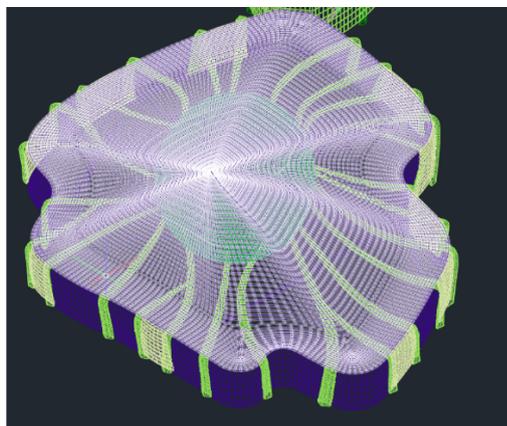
maillage de la nappe tridimensionnelle de la toiture du socle
